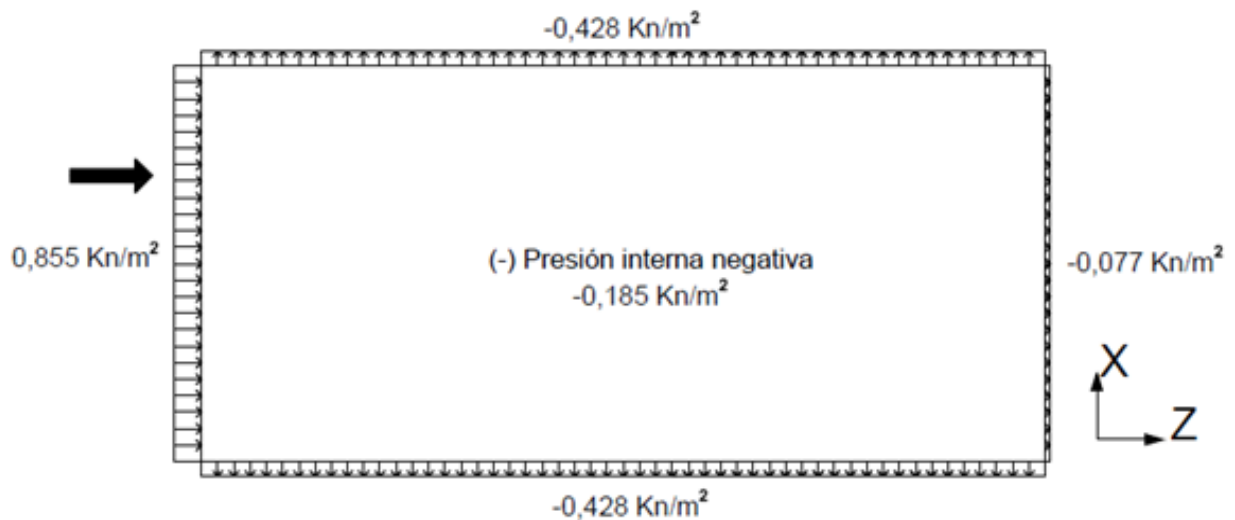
Vista en planta-Presiones de viento en la estructura
